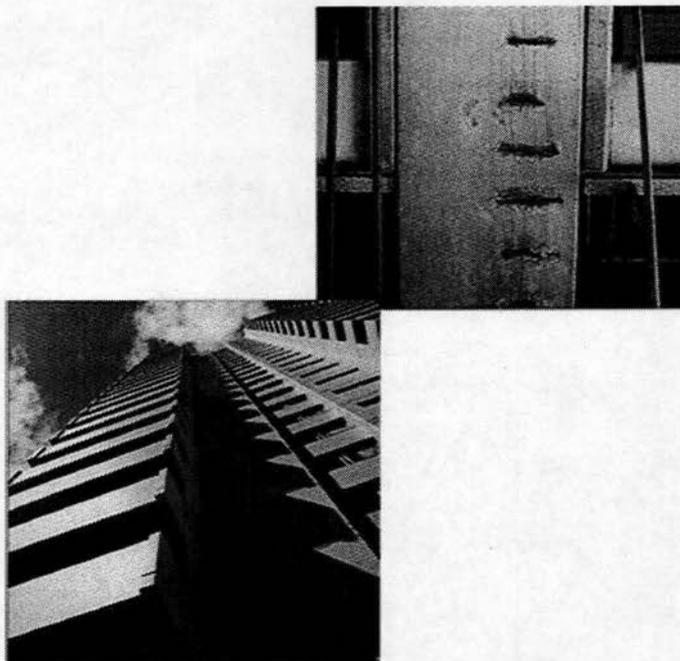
Edificio de apartamentos en estructura de concreto y paneles prefabricados en fachada.
